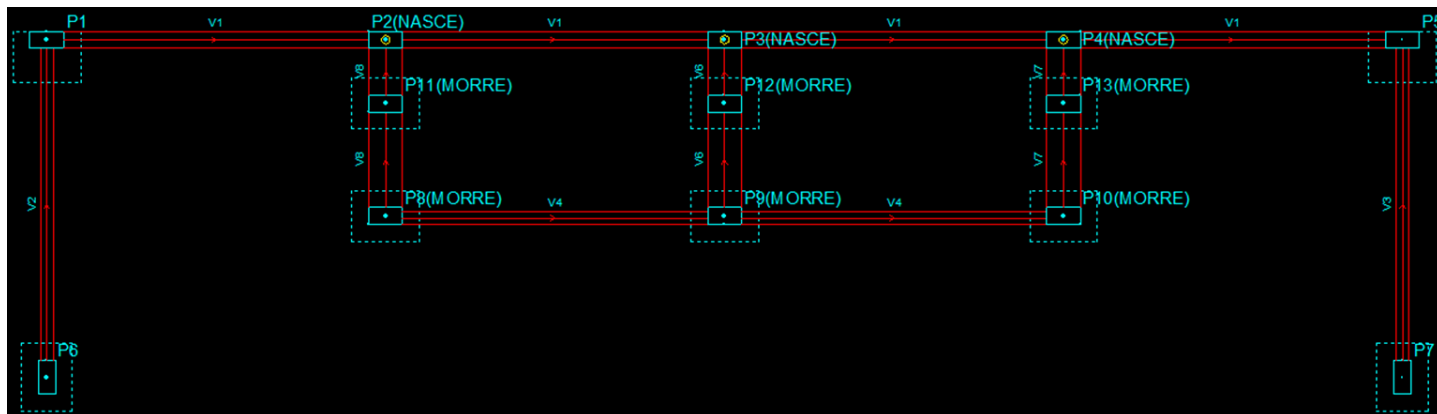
Lançamento do pavimento “ Térreo ” utilizando vigas de equilíbrio
